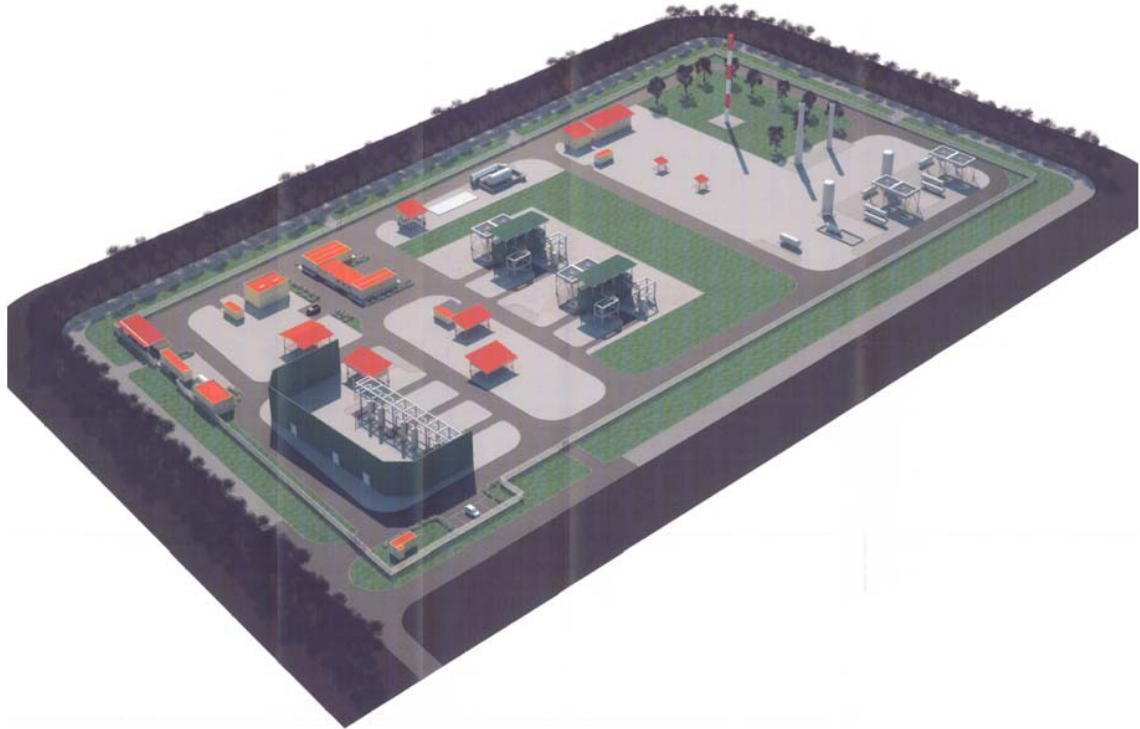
Modello Planovolumetrico, Centrale di Stoccaggio Gas – Fase 1
